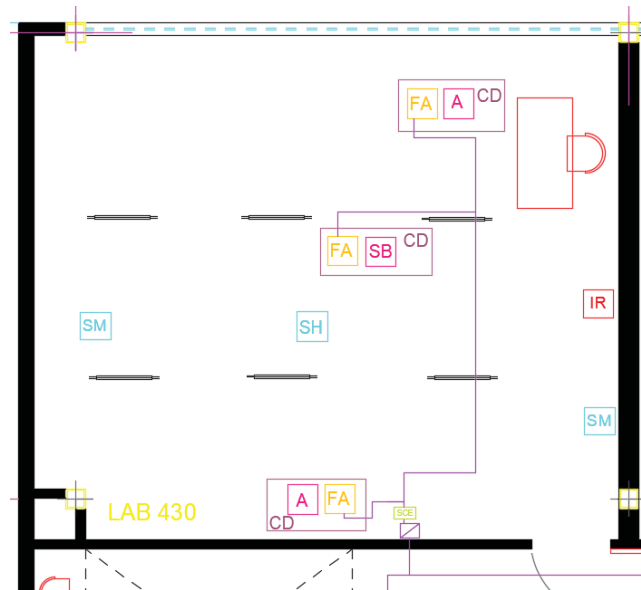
Corte de plano Reingeniería Eléctrica en un laboratorio
